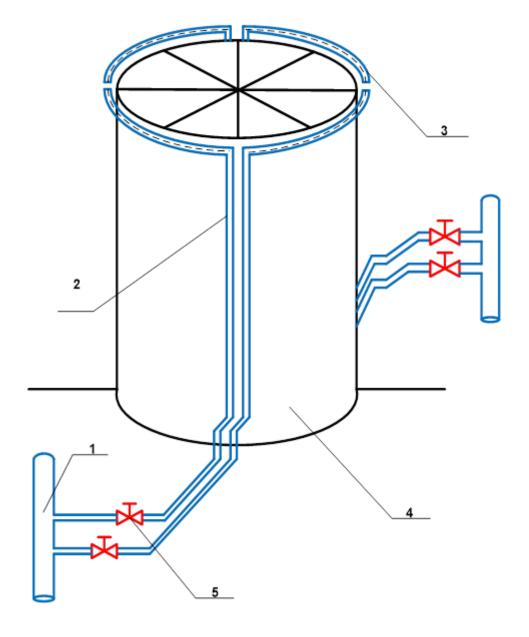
Конструктивные элементы установки охлаждения резервуара
